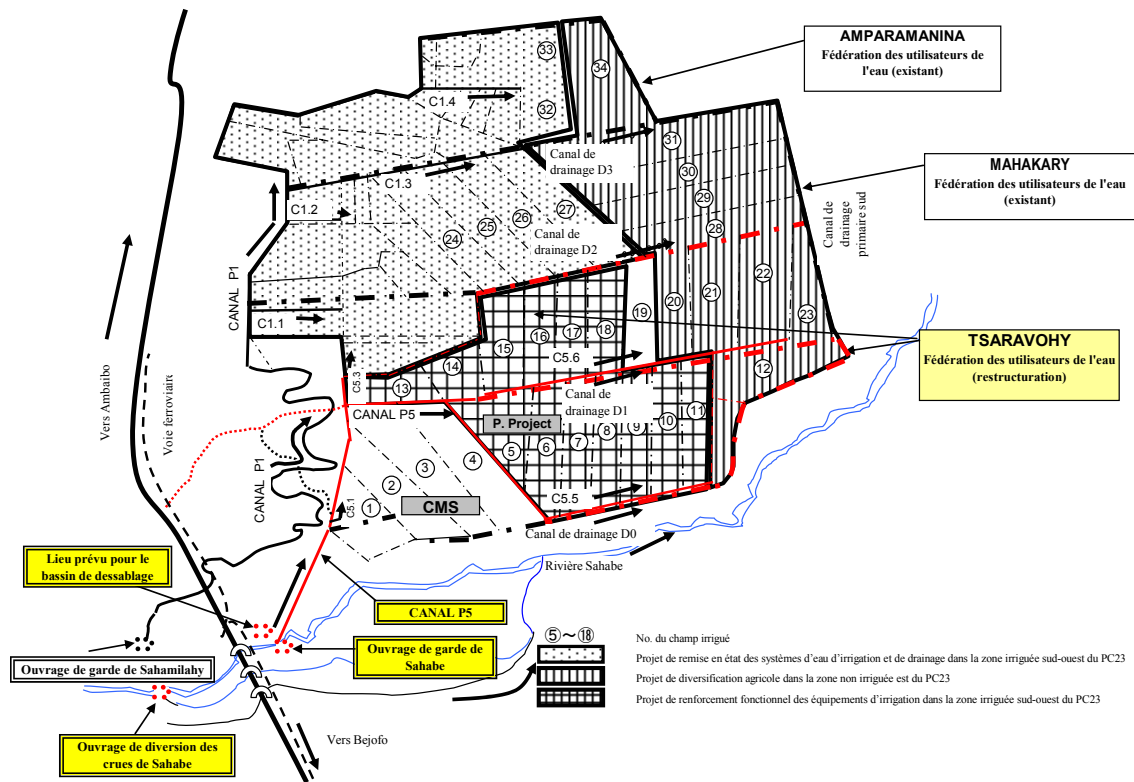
Plan de positionnement des trois projets de développement dans la zone
